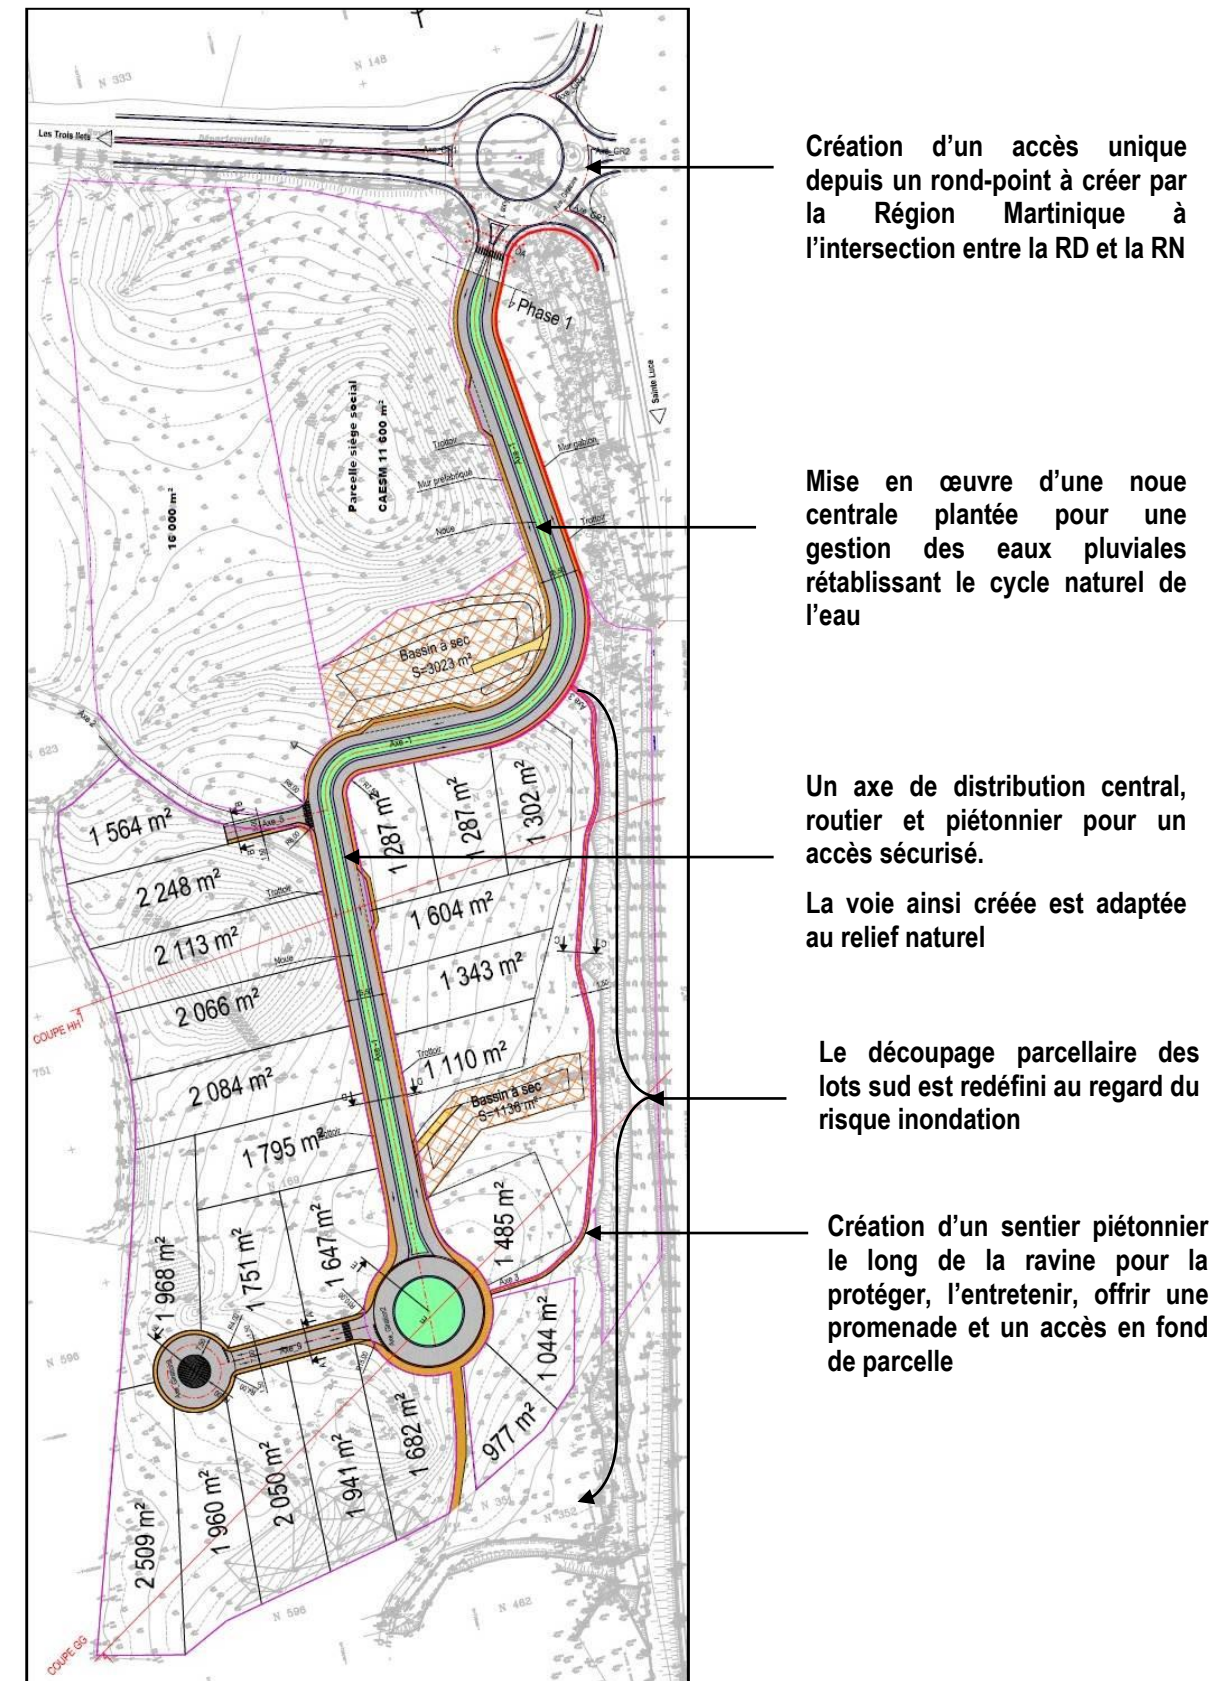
Plan d'aménagement de la ZAE de Maupeou, à l'issue des études d'avant-projet 2015
